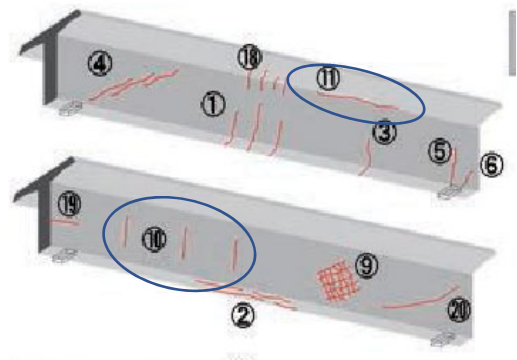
ポステン PC 桁のひび割れ発生パターン⁷⁾
